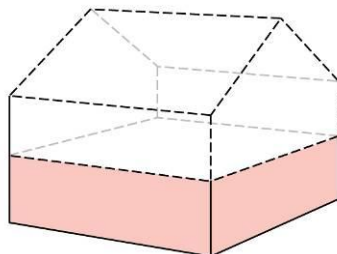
Abriss und identischer Ersatz des Dachs und eines Teils der Fassade: Das oberste Geschoss und das Dach werden ersetzt.
